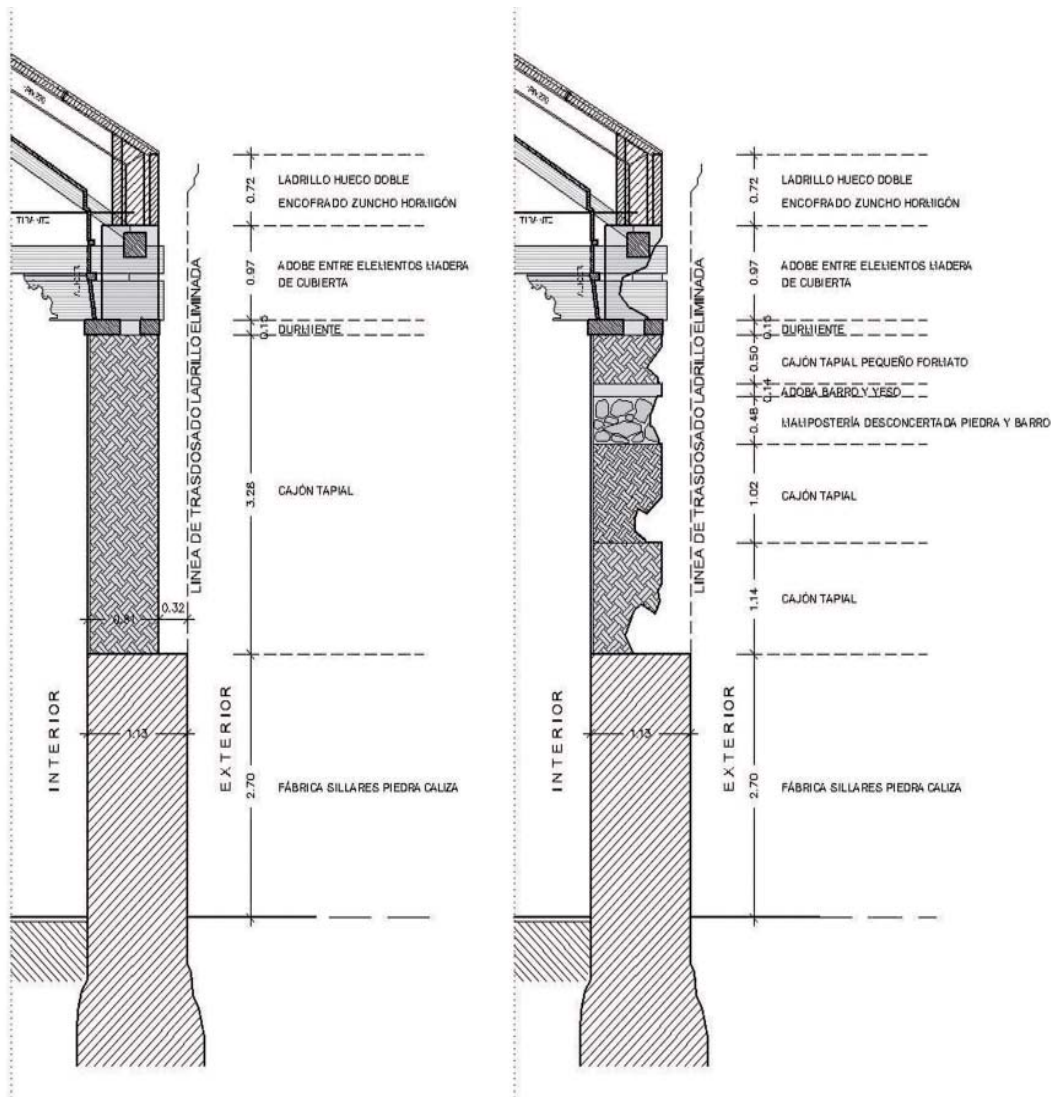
Sección constructiva del muro sur. Estado comparado entre la sección tipo definida en proyecto y la sección real, con indicación de las diferentes hiladas de cajones y su composición. (Dibujos: Pinés & Jové - Arquitectos).
